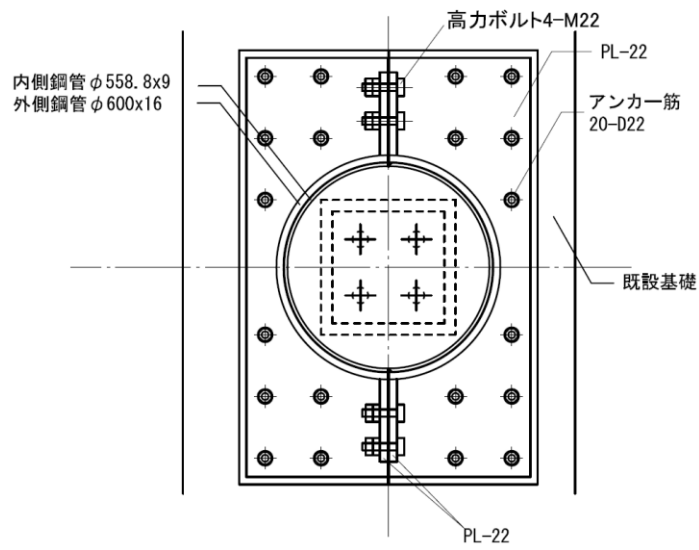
補強鋼管とあと施工アンカー詳細 (伏図)
